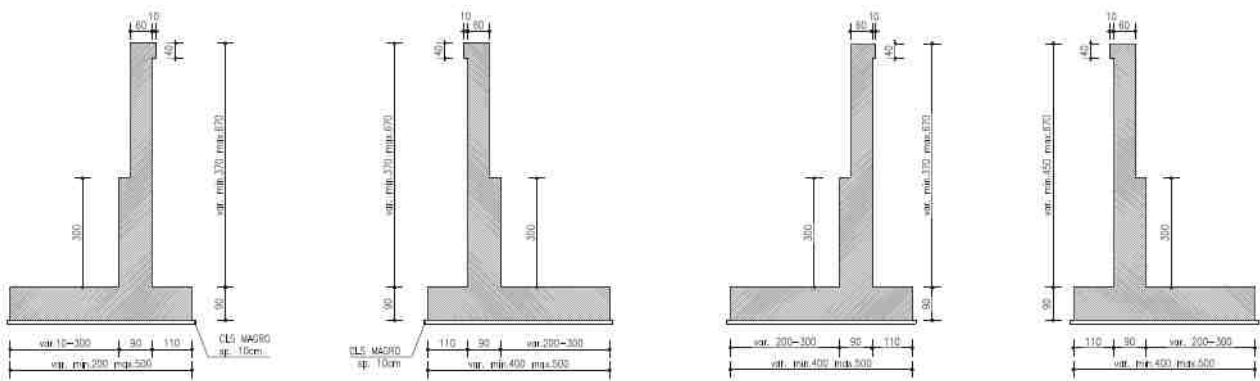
Spalla 2 – Muri di imbocco/sbocco – sezioni trasversali tipo
